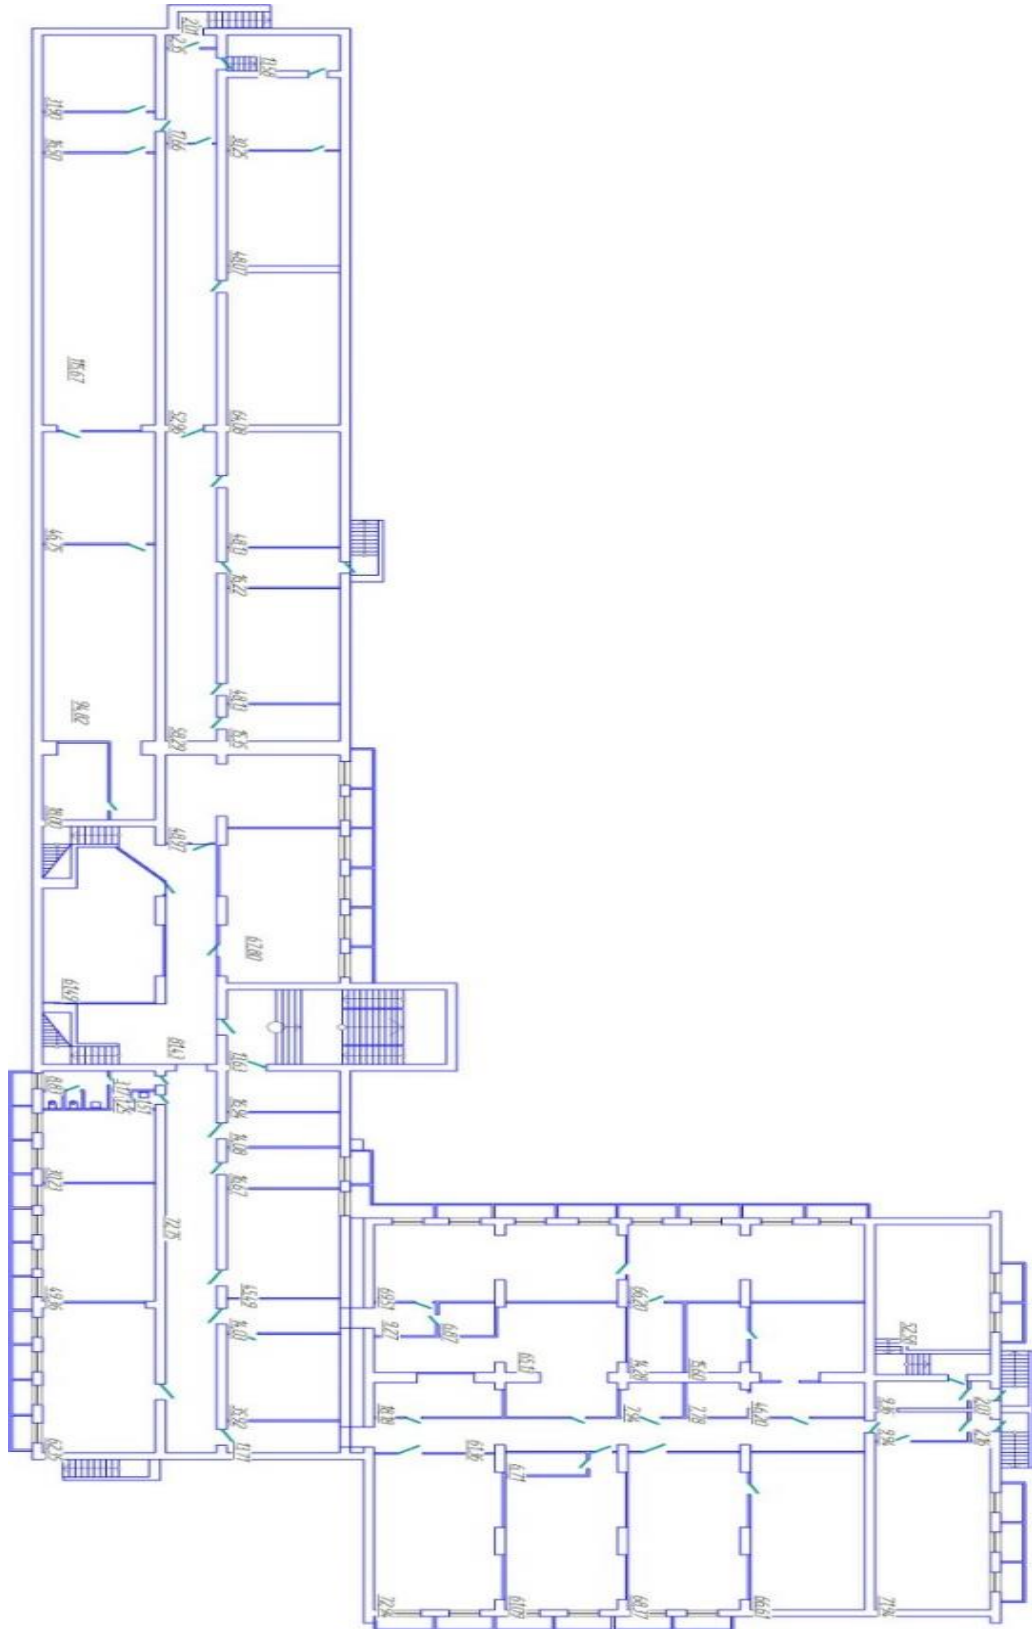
План цокольного поверху будівлі для проектування системи.
